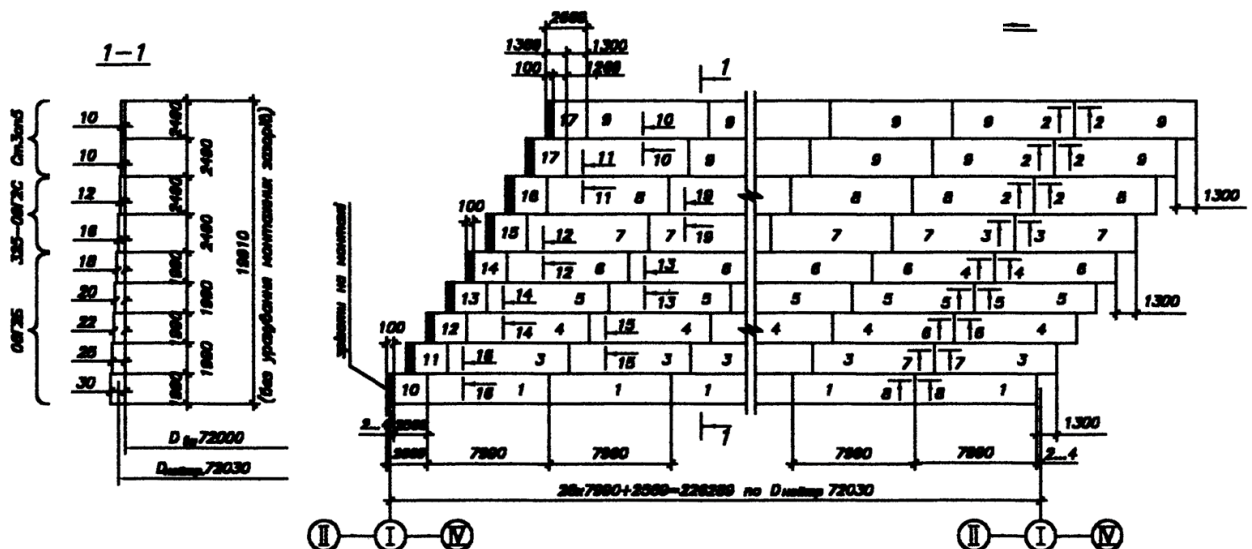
Схема розкладки листів для внутрішньої стінки резервуару
